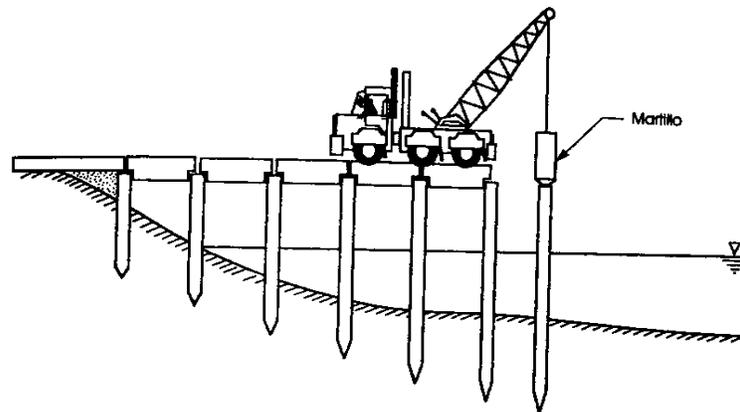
Construcción de Tierra a mar en avance apoyado sobre pórticos conformado por pilotes y vigas.
